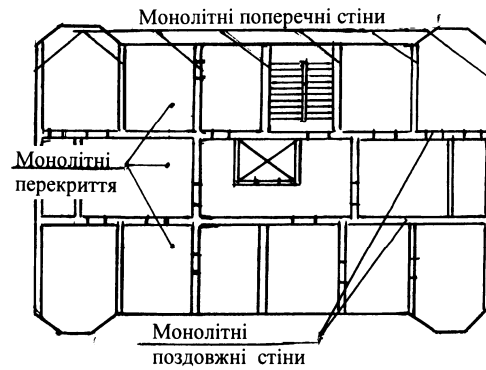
План розташування поздовжніх і поперечних стін у будинках пластинчастого каркасу
